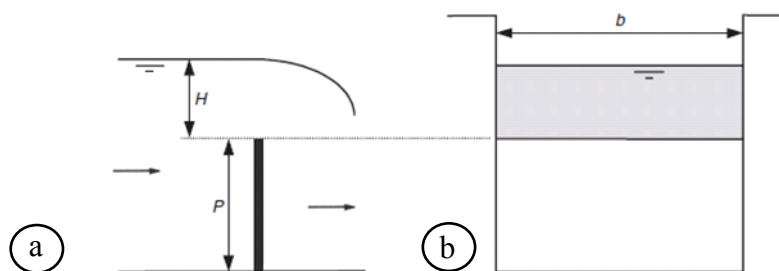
Descarregador transversal retangular: a) corte lateral; b) corte transversal (adaptado de Butler e Davies, 2011)
